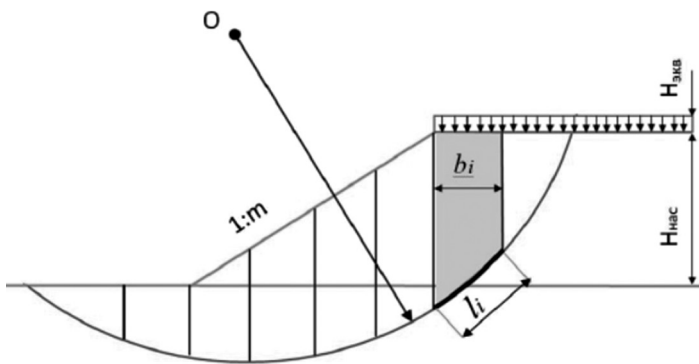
Схема к расчету устойчивости откоса насыпи на слабом основании<sup>4</sup>
